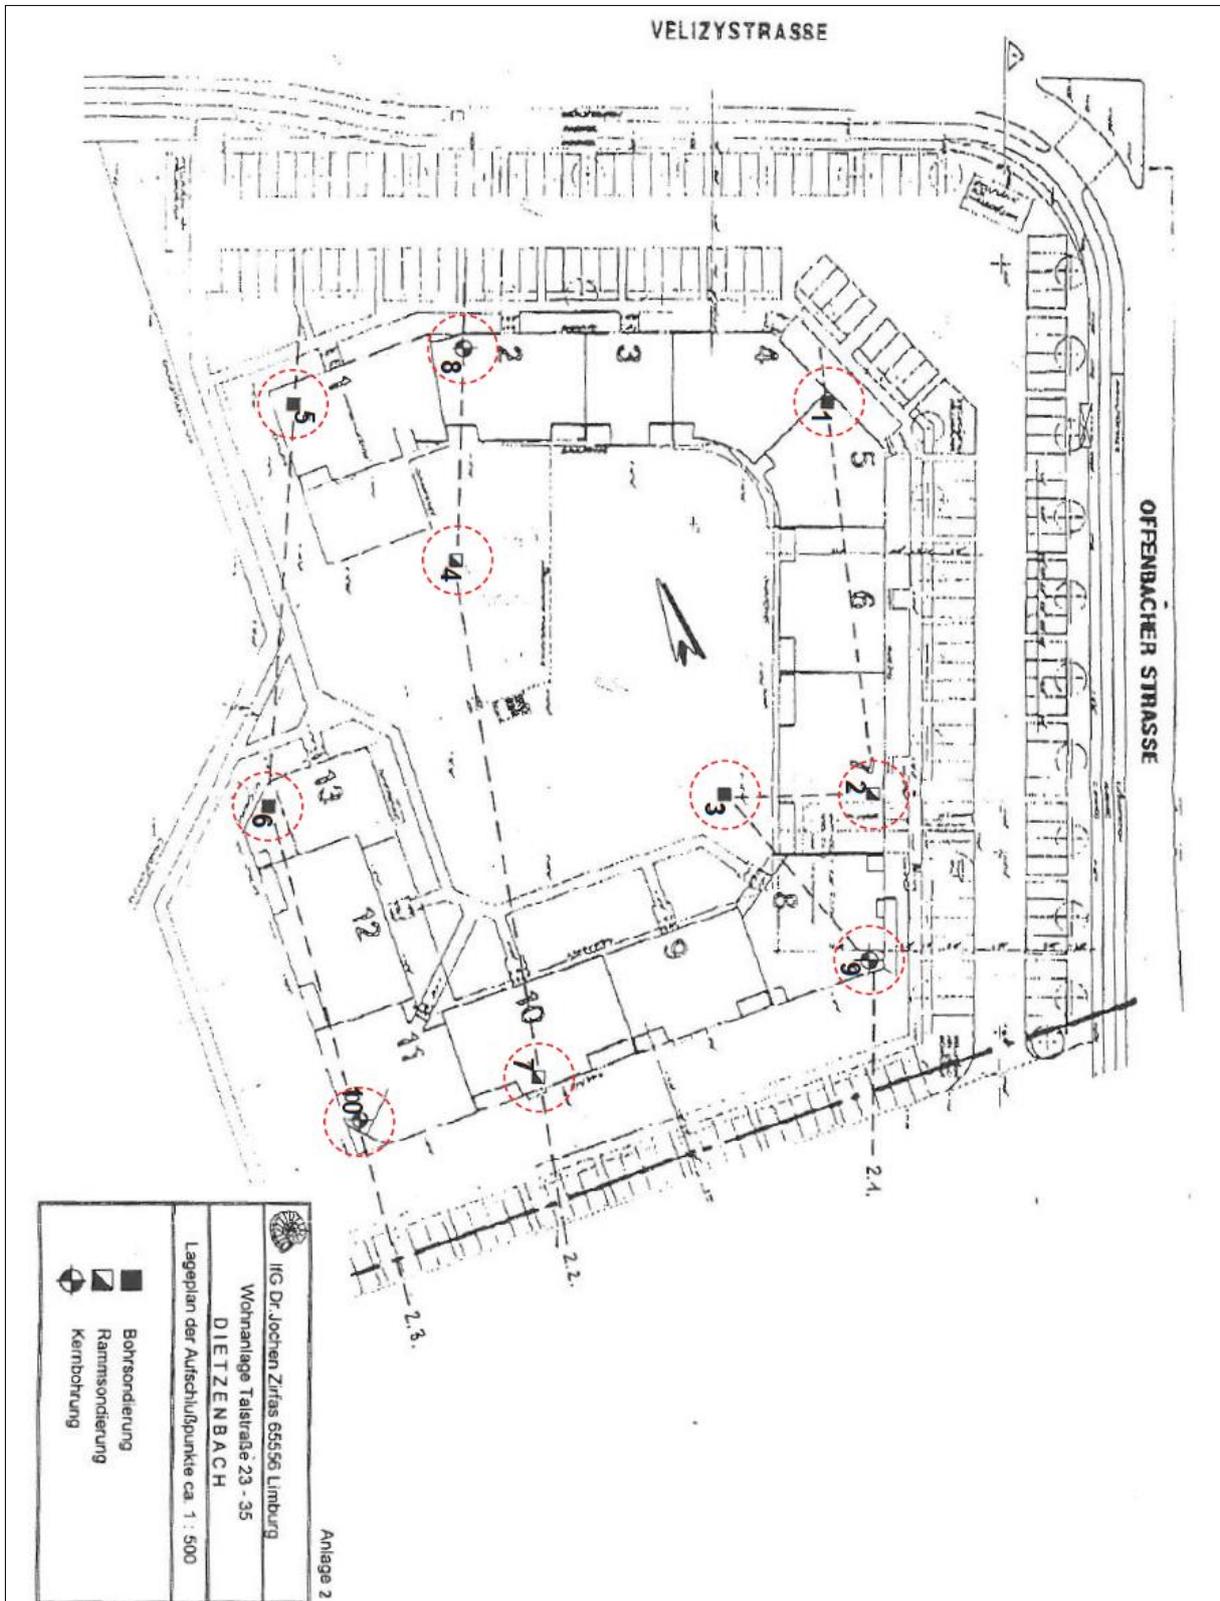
Lageplan der Aufschlußpunkte, Planungsgrundlage Bauvorhaben Oktober 1993 (Institut für Geotechnik, Dr Jochen Zirfas (März 1996): Geotechnisches Gutachten zum Projekt Talstraße Dietzenbach, Anlage 2)
